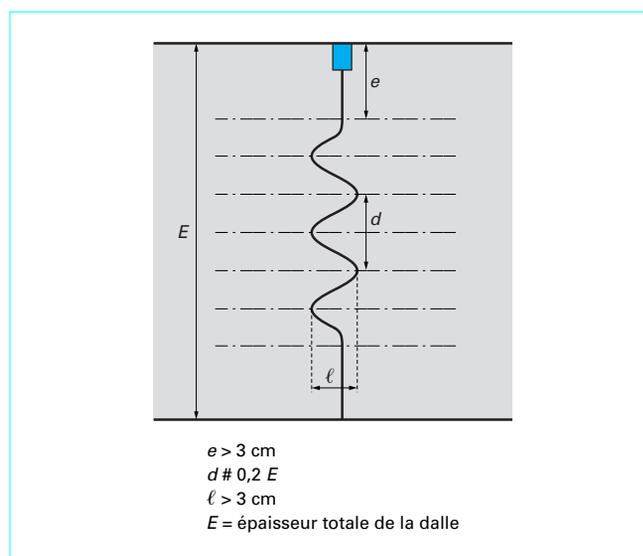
Profil vertical d'un joint longitudinal entre deux bandes de béton
